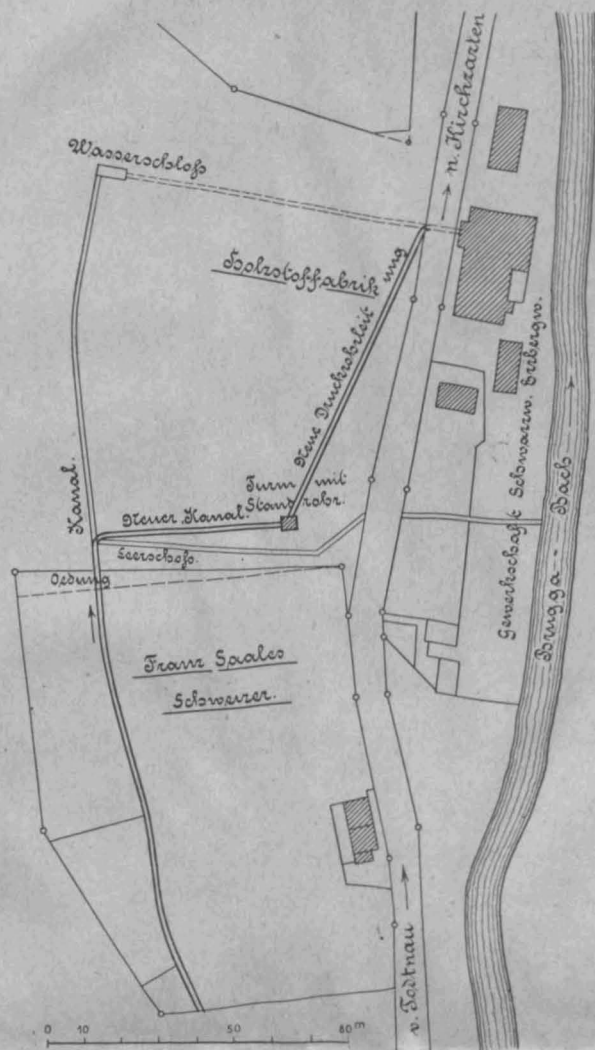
Gesamtansicht des Zuleitungs-Gerinnes mit den Steigschacht umhüllendem Turm.
